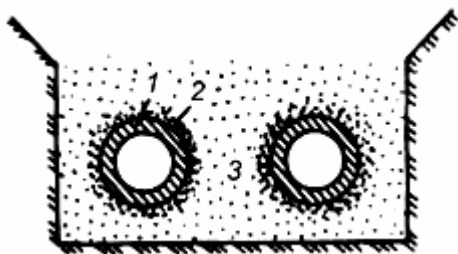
Бесканальная прокладка теплопровода в самоспекающемся асфальтоизоле
